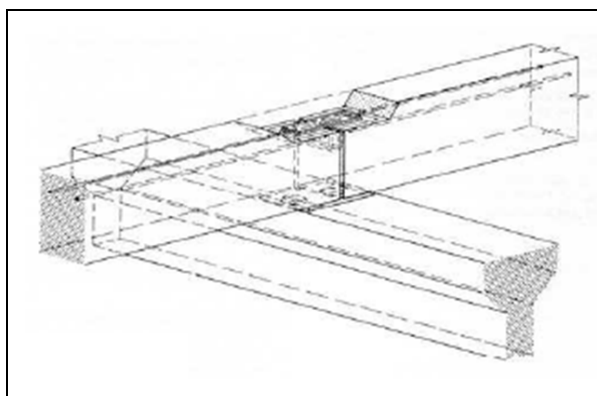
Ligação por chapas soldadas (Stupré, 1981)
